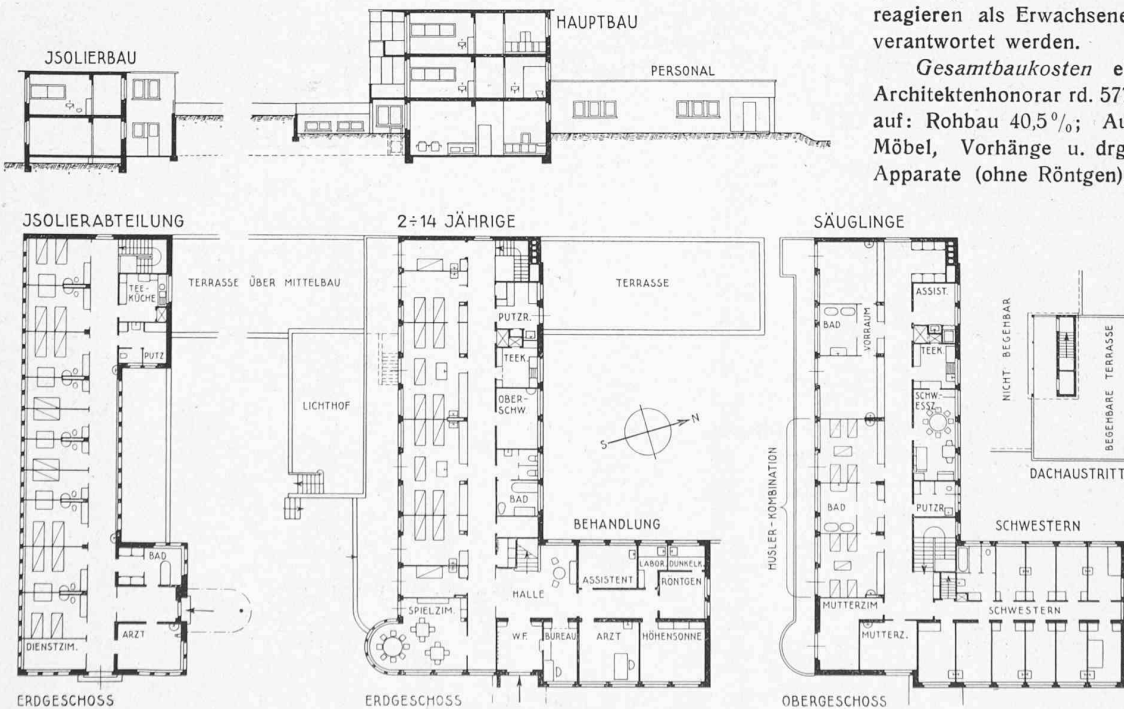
Erdgeschoss, darüber Schnitte. — Masstab 1 : 500. — Rechts Obergeschoss und Dach-Austritt vom Hauptbau.
